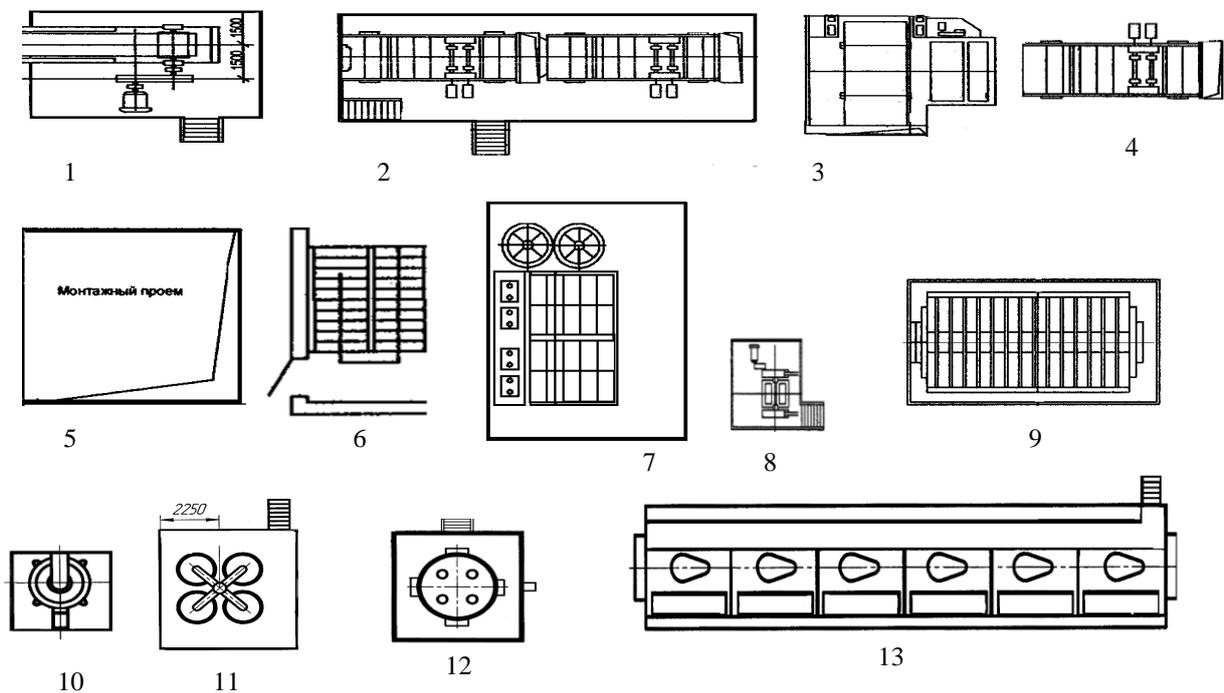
Набор видов оборудования и элементов здания для установки их на плане:
